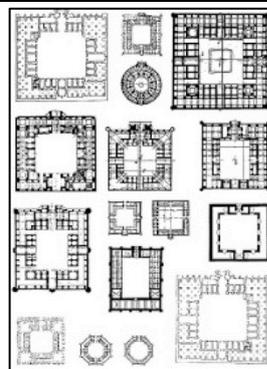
typologies des caravansérails en plan. On observe des différences de typologie en plan et dans la forme extérieure des caravansérails mais ces différences sont subtiles. Pour la plupart ils suivent un plan carré ou octogonale. s'organisaient autour d'une cour centrale entourées de pièces servant à loger les
